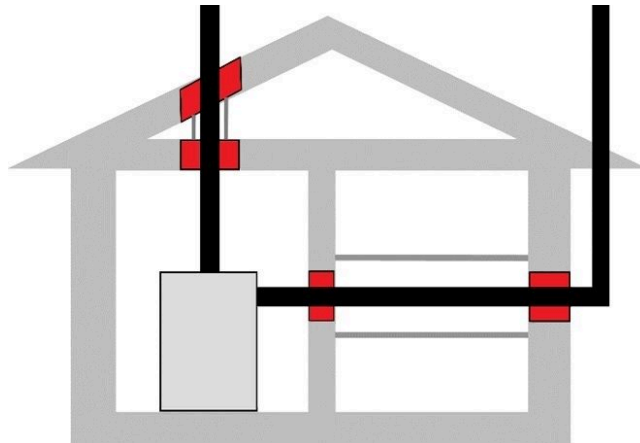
Einsatzbereich für Wand-, Decken und Dachdurchführung
